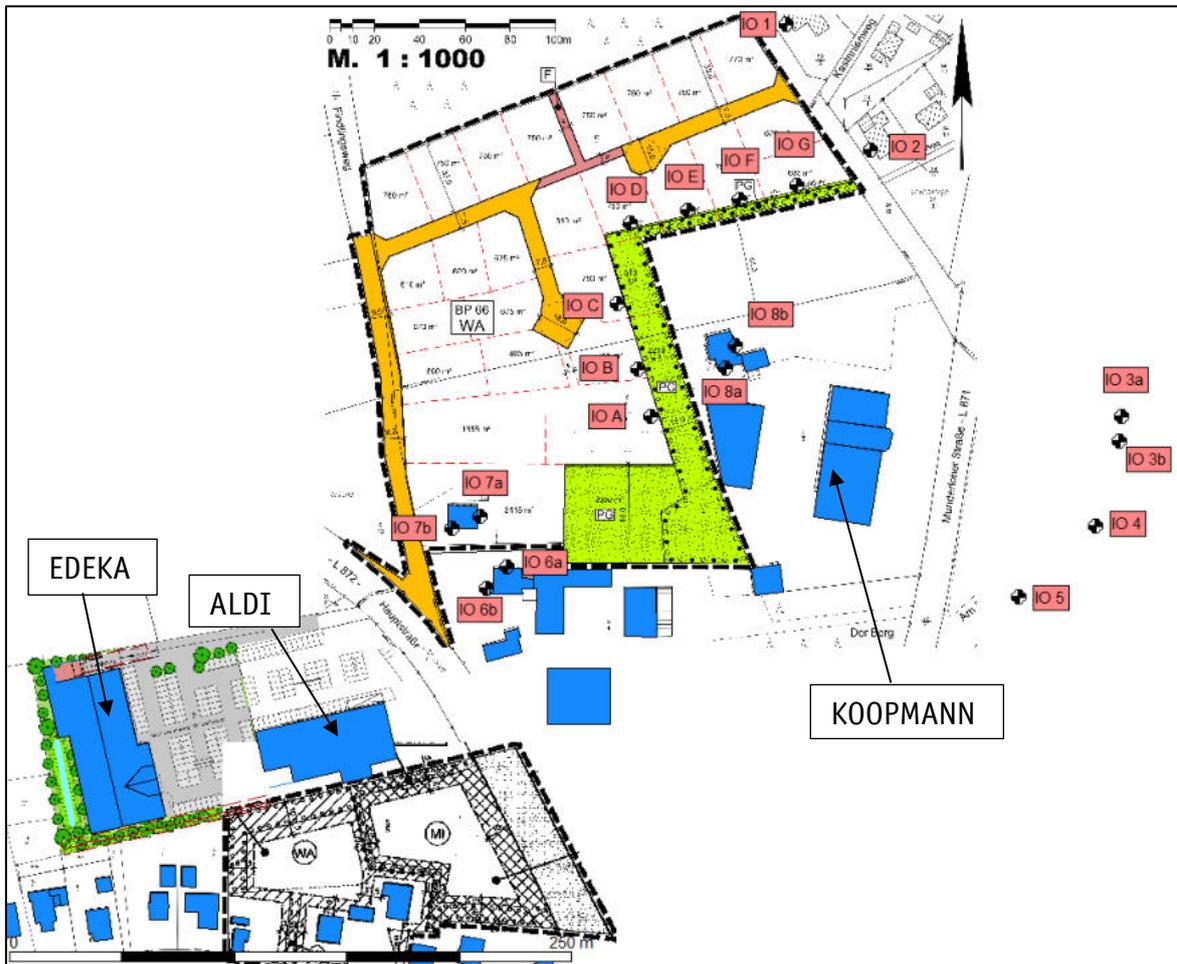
Lage der Immissionsorte in der beurteilungsrelevanten Umgebung des Plangebiets (IO A bis G: geplante Wohnfläche; IO 1 bis 8: bereits vorhandene Wohngebäude).
